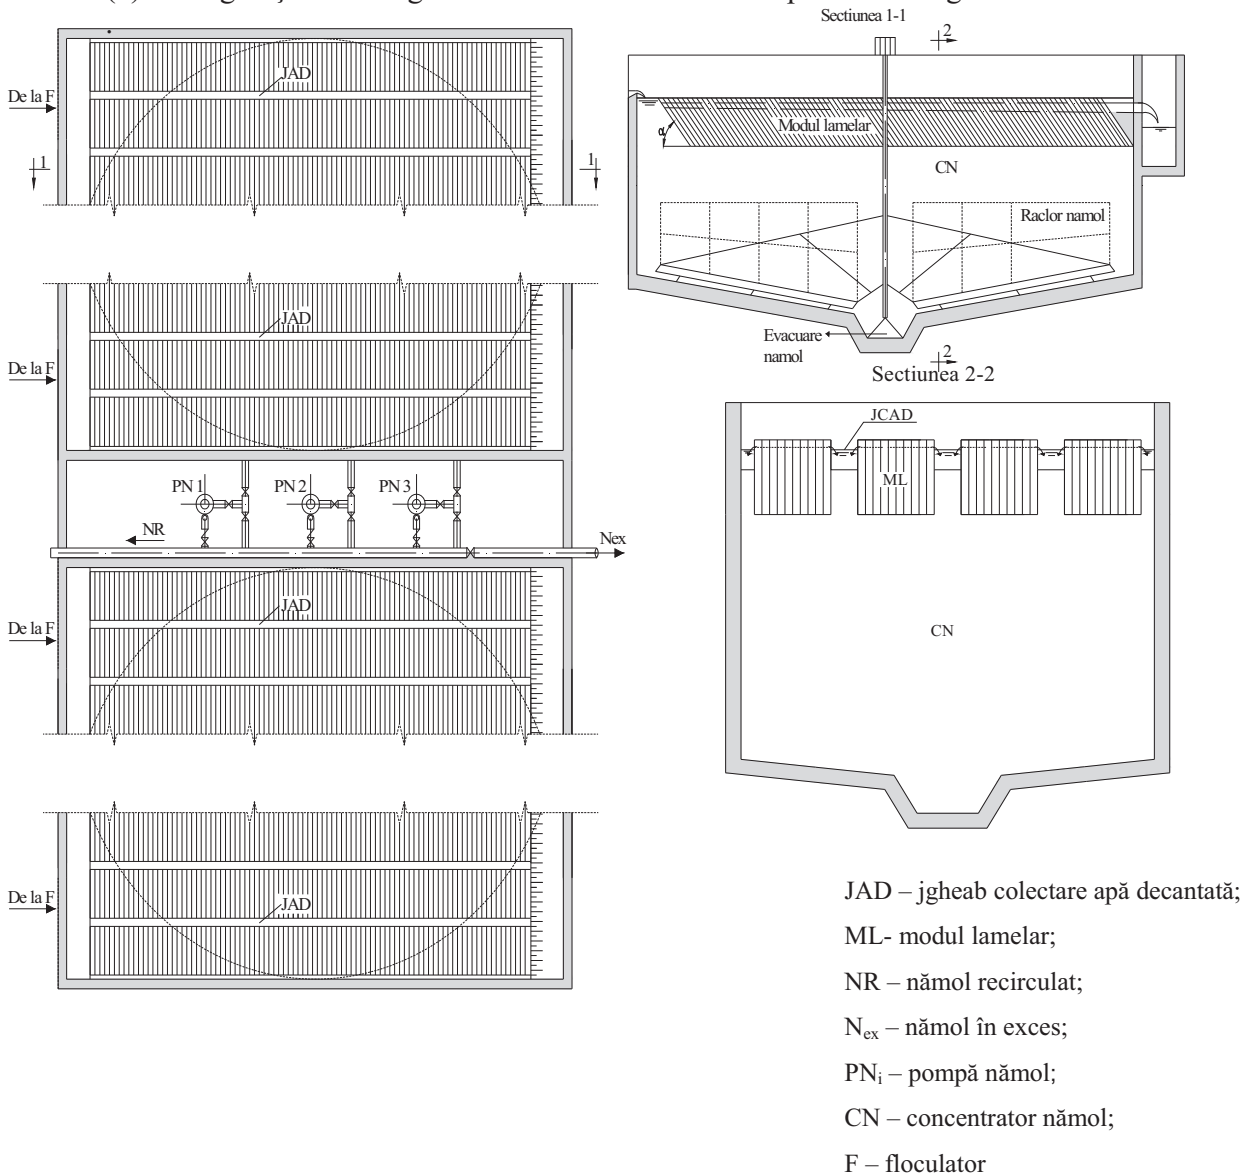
Plan și secțiune prin decantorul lamelar.
